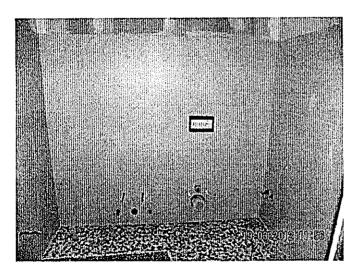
Stanza 1.7- Bagno, Particolare interno con impianti posati
